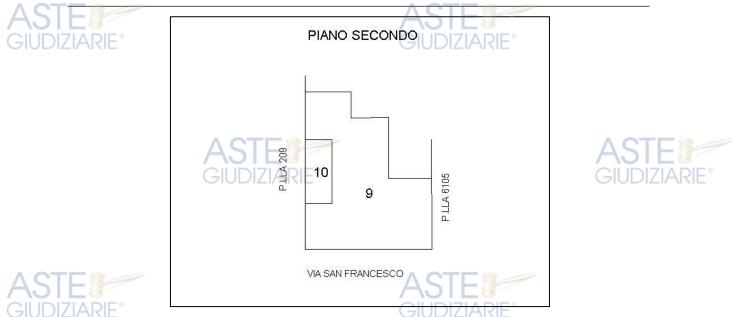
Elaborato planimetrico catastale con identificazione degli immobili pignorati
